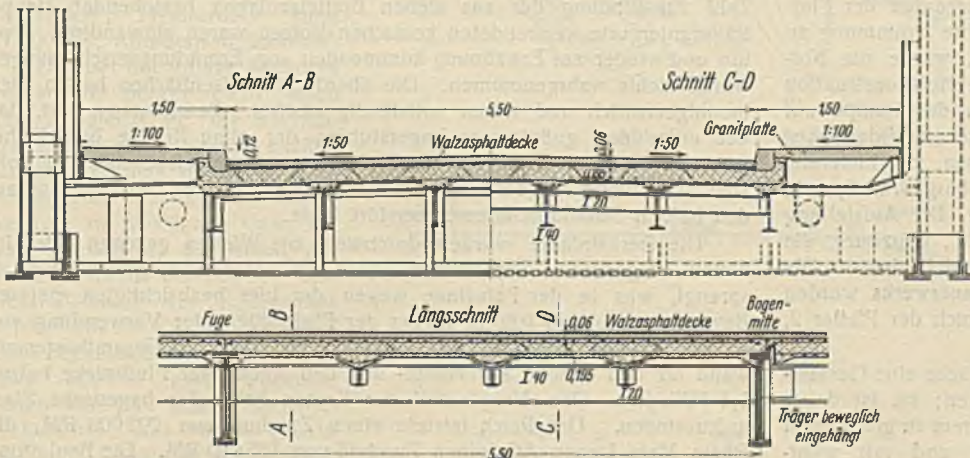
Eisenbetondecke der Schiffahrtöffnung.
